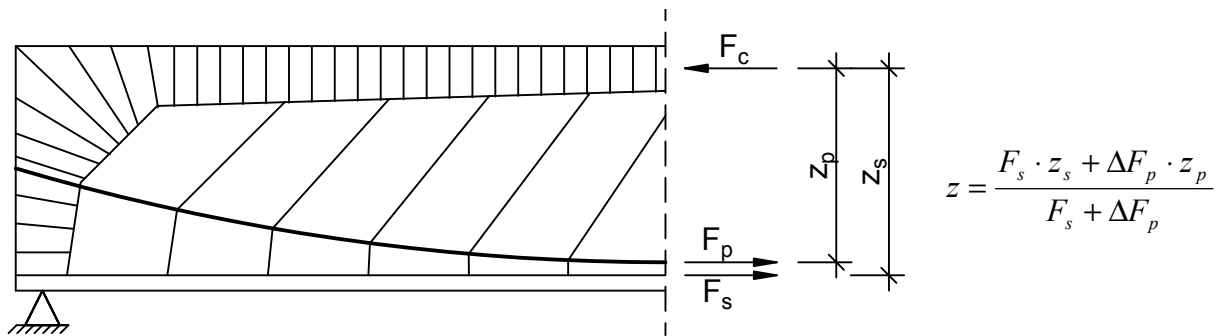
Fachwerkmodell eines Spannbetonbalkens mit zwei Zuggurten an der Innenstütze
